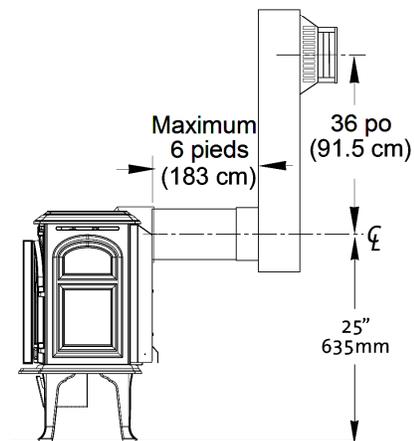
Conduit d'évacuation horizontal maximum avec terminaison tuba (*Snorkel*) de 36 po.
